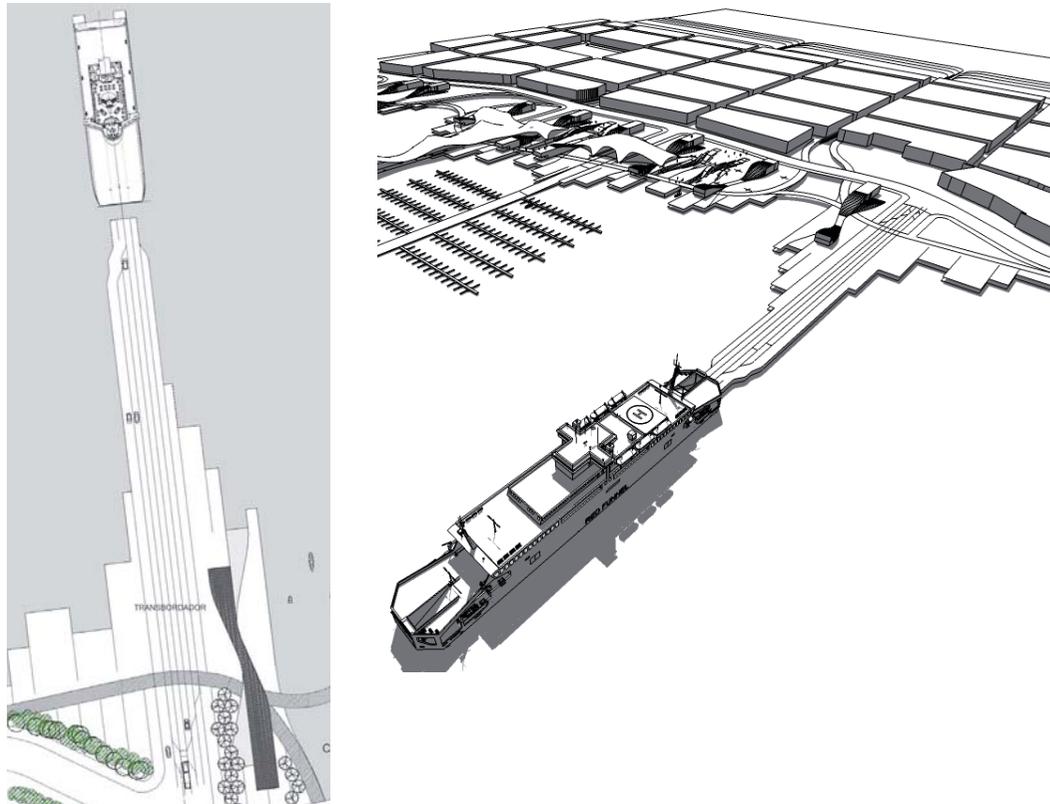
JC. Olivas. Planimetría y volumetría del área desarrollada.2012.
